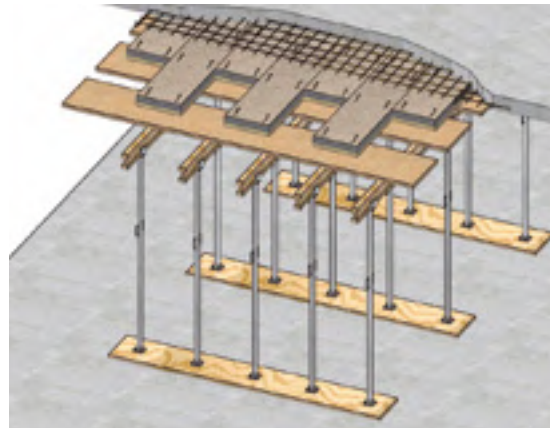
Mise en place des panneaux en coffrage isolant traditionnel
